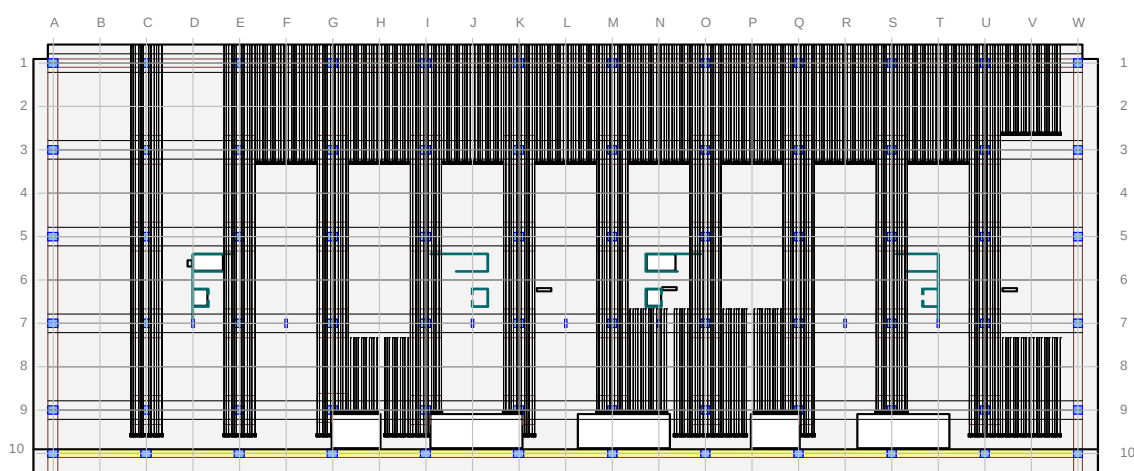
Planta pretensado dirección Y – Estadios 2 y 3
